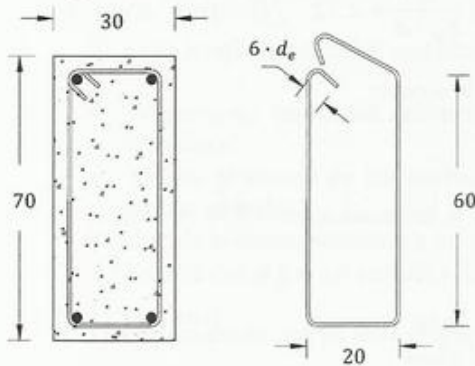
Viga en Balcón (Ejemplo 10.1)
